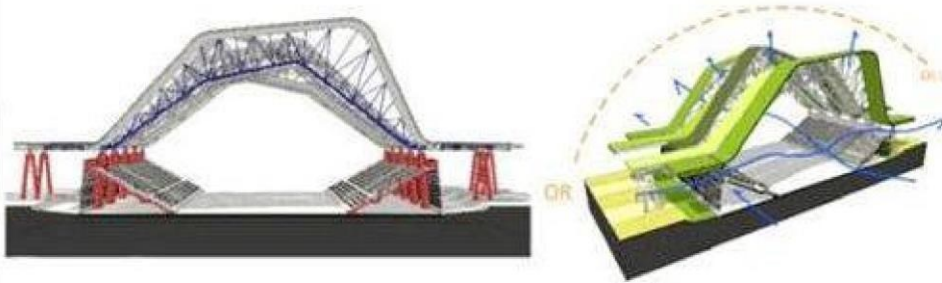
PLANTA PLANO CUBIERTA FUENTE:
